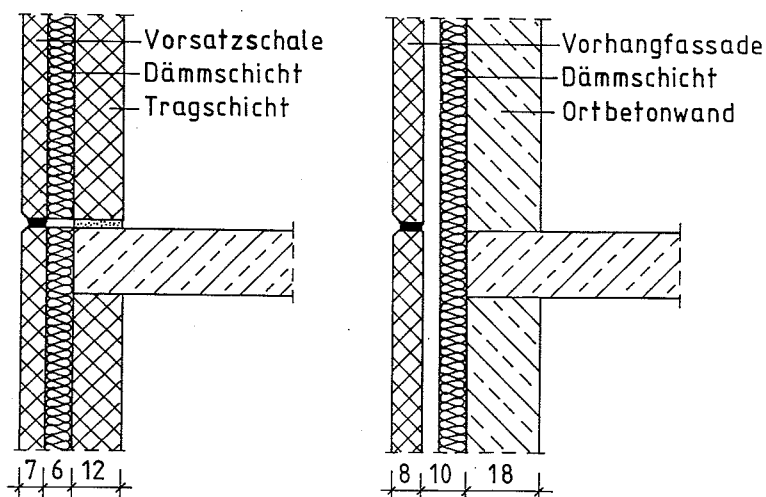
Aufbau einer Betonsandwichtafel im Vergleich zur Ortbetonwand mit Vorhangfassade
